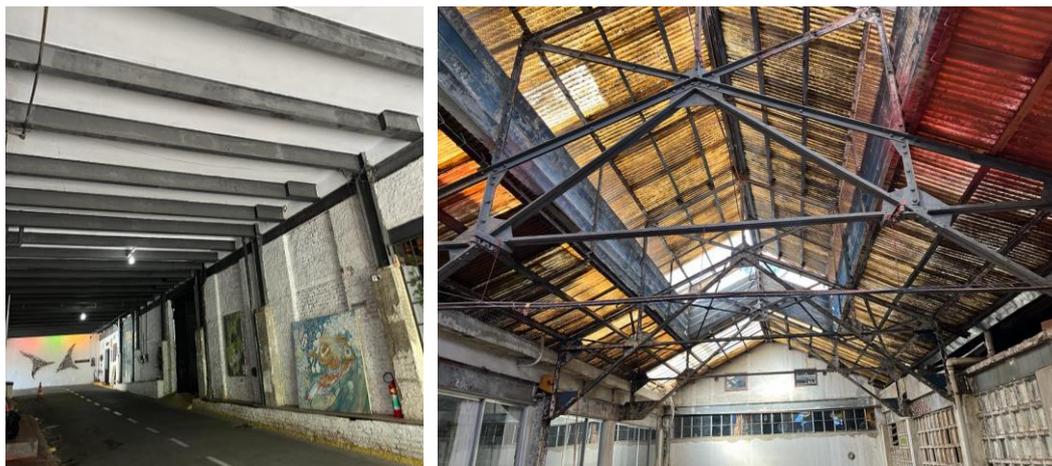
Destaque na estrutura metálica no térreo e no último pavimento. (F. Fotos realizadas em 24/maio/2023).
